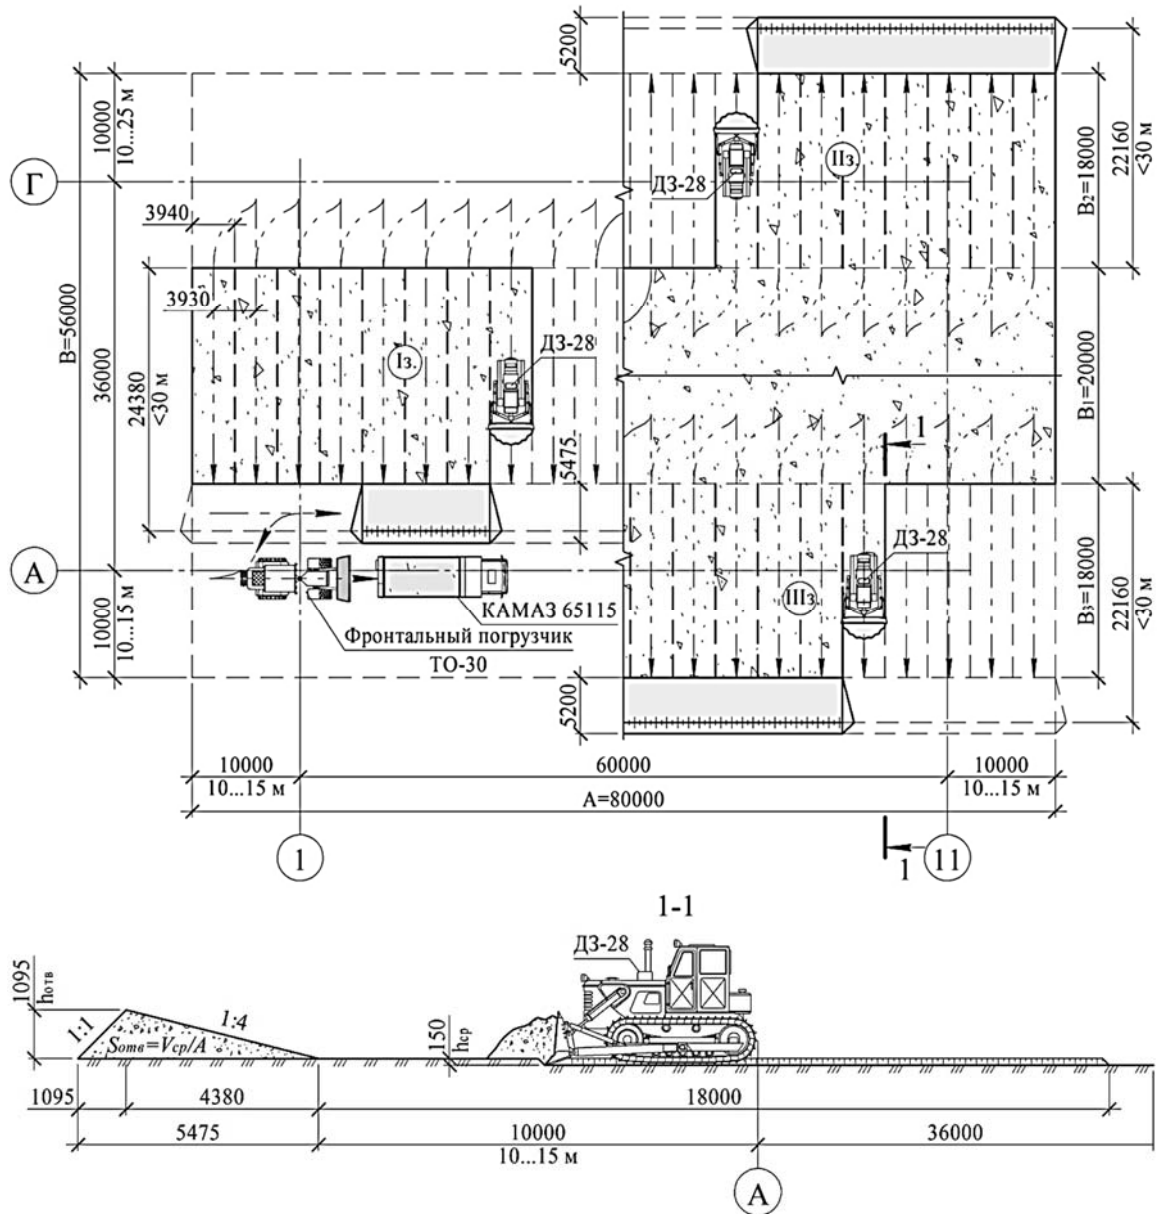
Примерная схема срезки растительного слоя грунта
